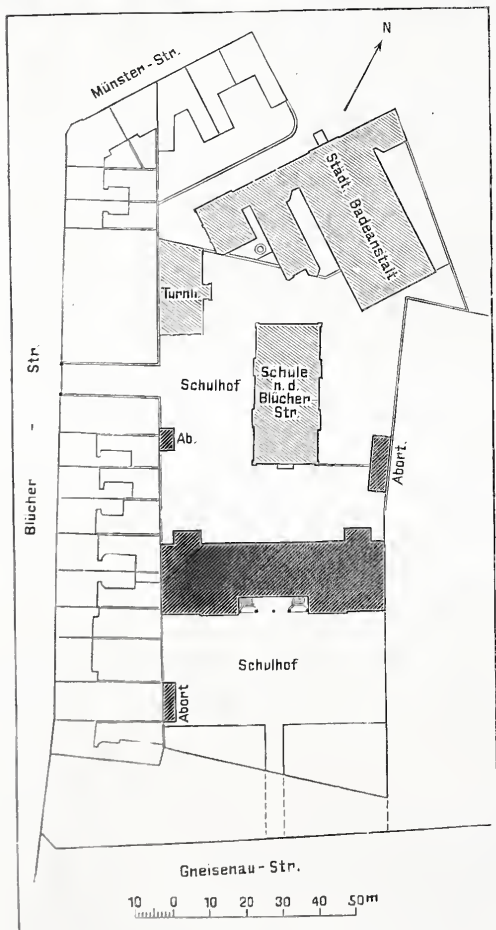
Schule an der Gneisenaustr. Lageplan.
